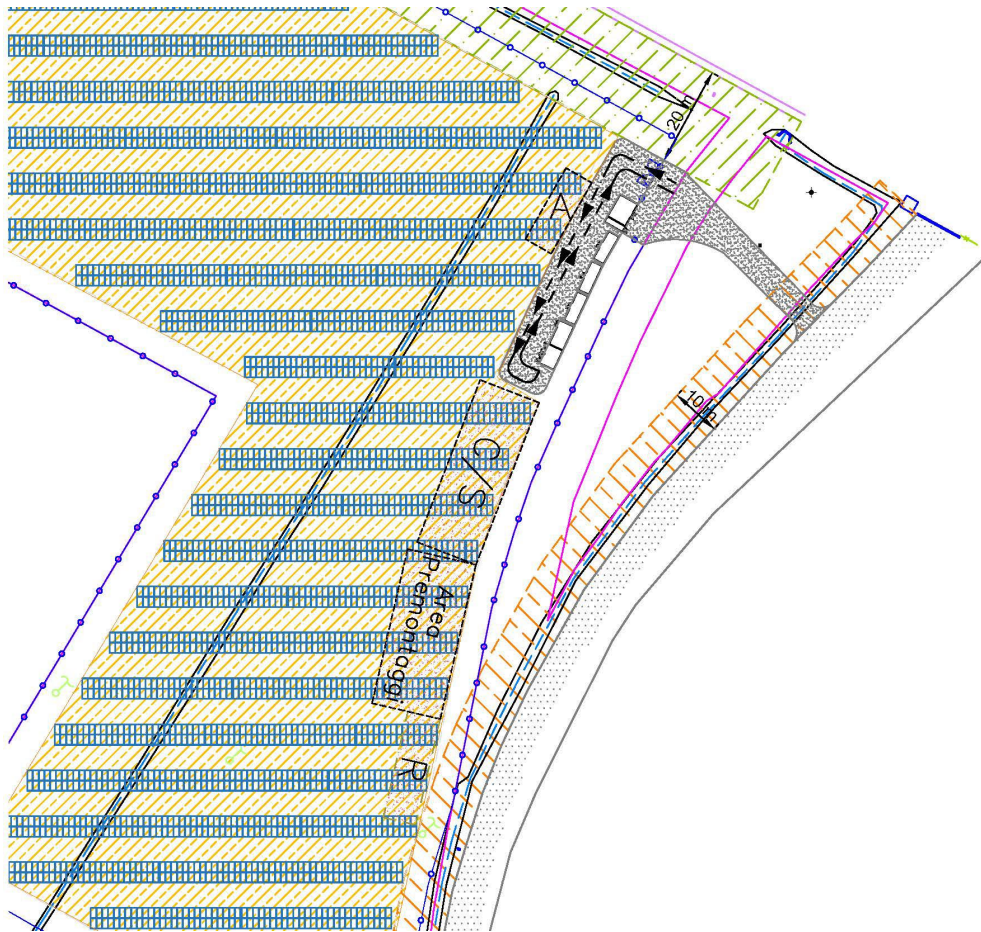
Area di cantiere impianto "Ozzano 3"
